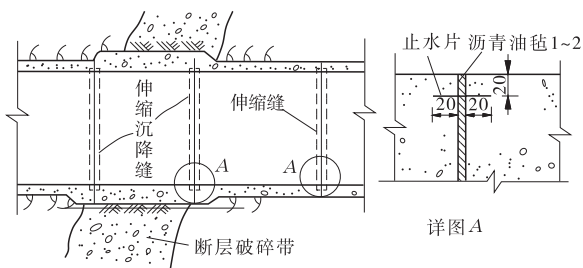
隧洞衬砌伸缩变形缝与止水构造 (单位:cm)
